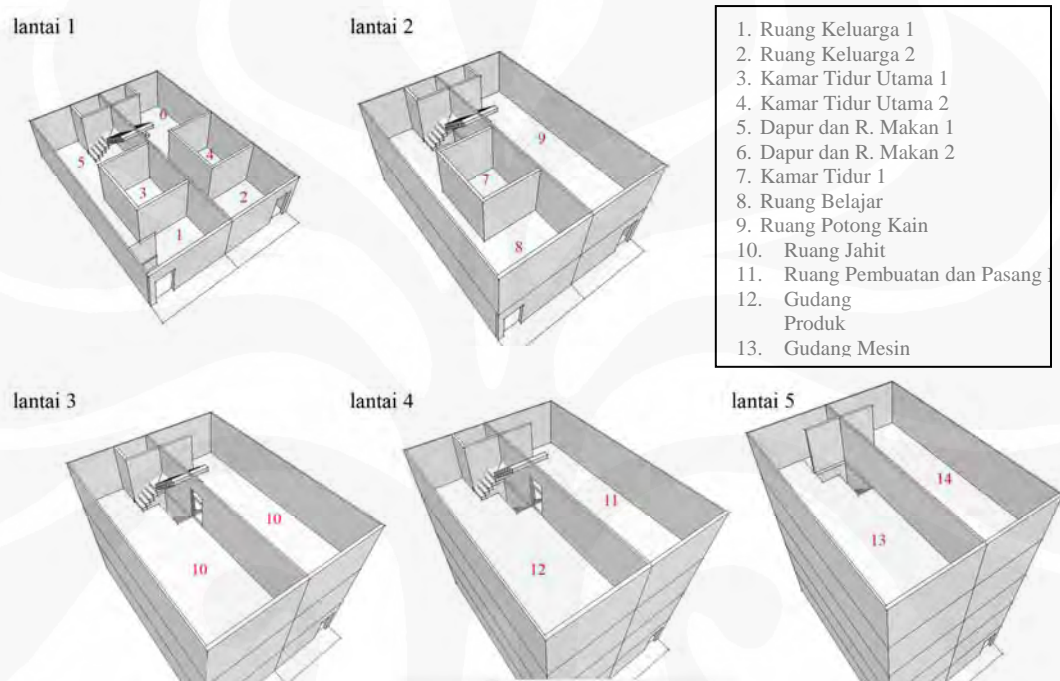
Layout ruang yang dibuat pengembang di Jembatan-Tiga (sama di tiap lantai)
